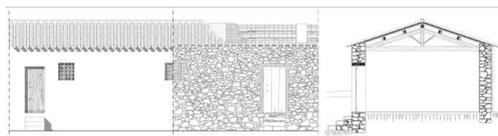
Medau nel territorio di Teulada, prospetto e sezione
